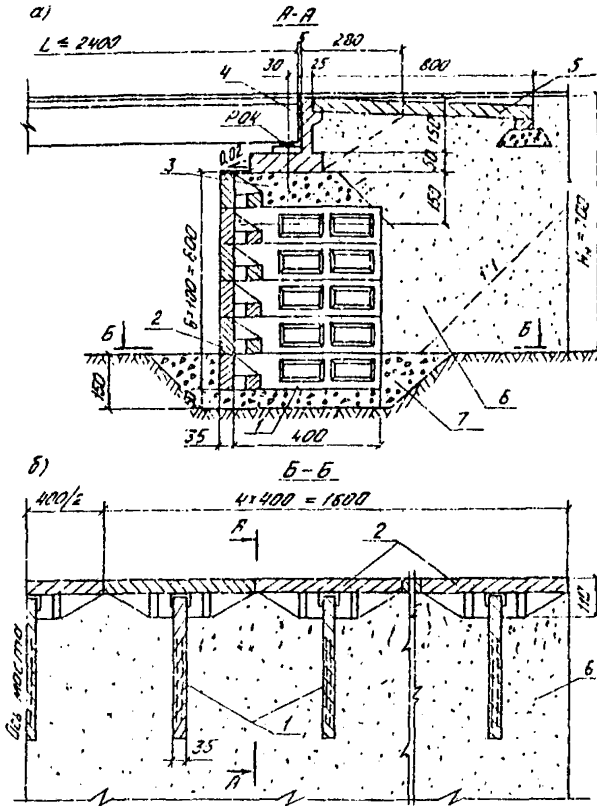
Конструкция анкерно-контрфорсного устоя из сборных железобетонных элементов: а - разрез вдоль оси моста; б - план расположения элементов устоя; 1 - блок контрфорса; 2 - уголкового блока лицевой стенки; 3 - распределительная подушка из щебня или гравия; 4 - диванный блок; 5 - переходные плиты; 6 - дренирующий грунт обратной засышки; 7 - засыпка из утрамбованного щебня или гравия
